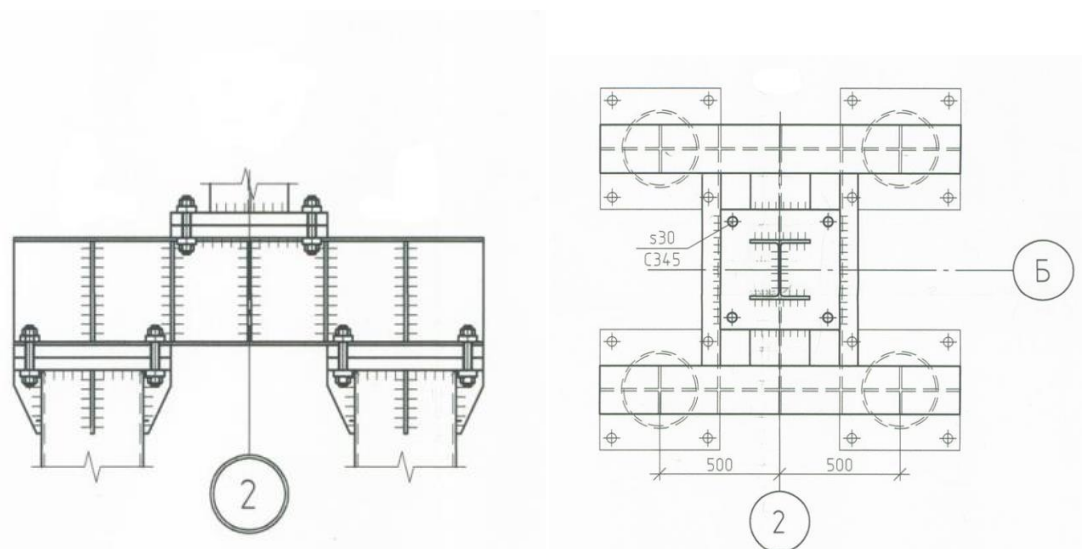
Схема к расчету балки оголовников свай.
